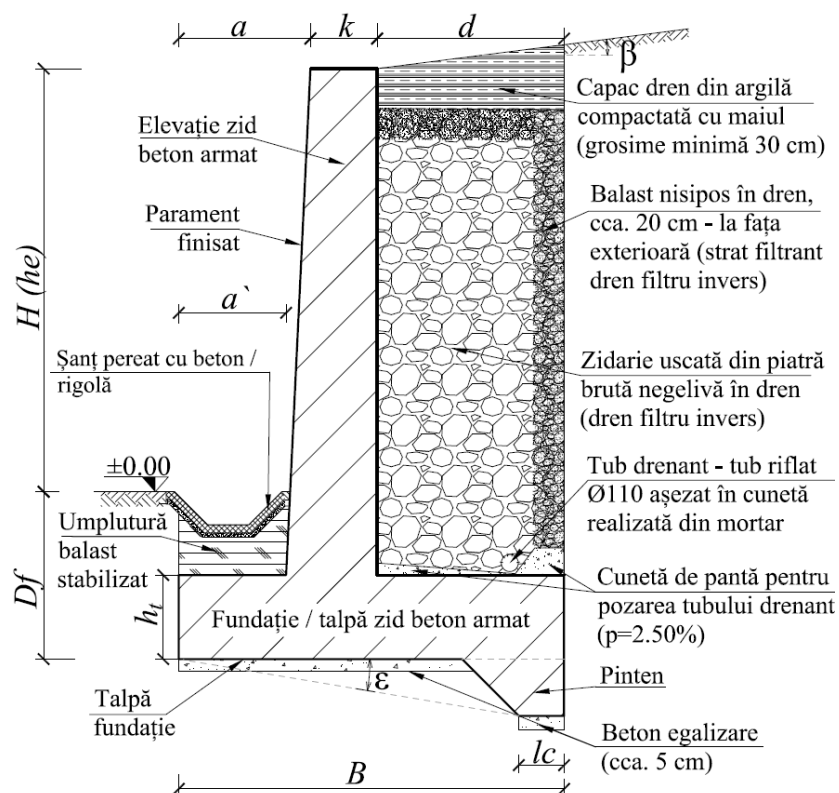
Secțiune transversală zid de sprijin din beton armat fără barbacane
